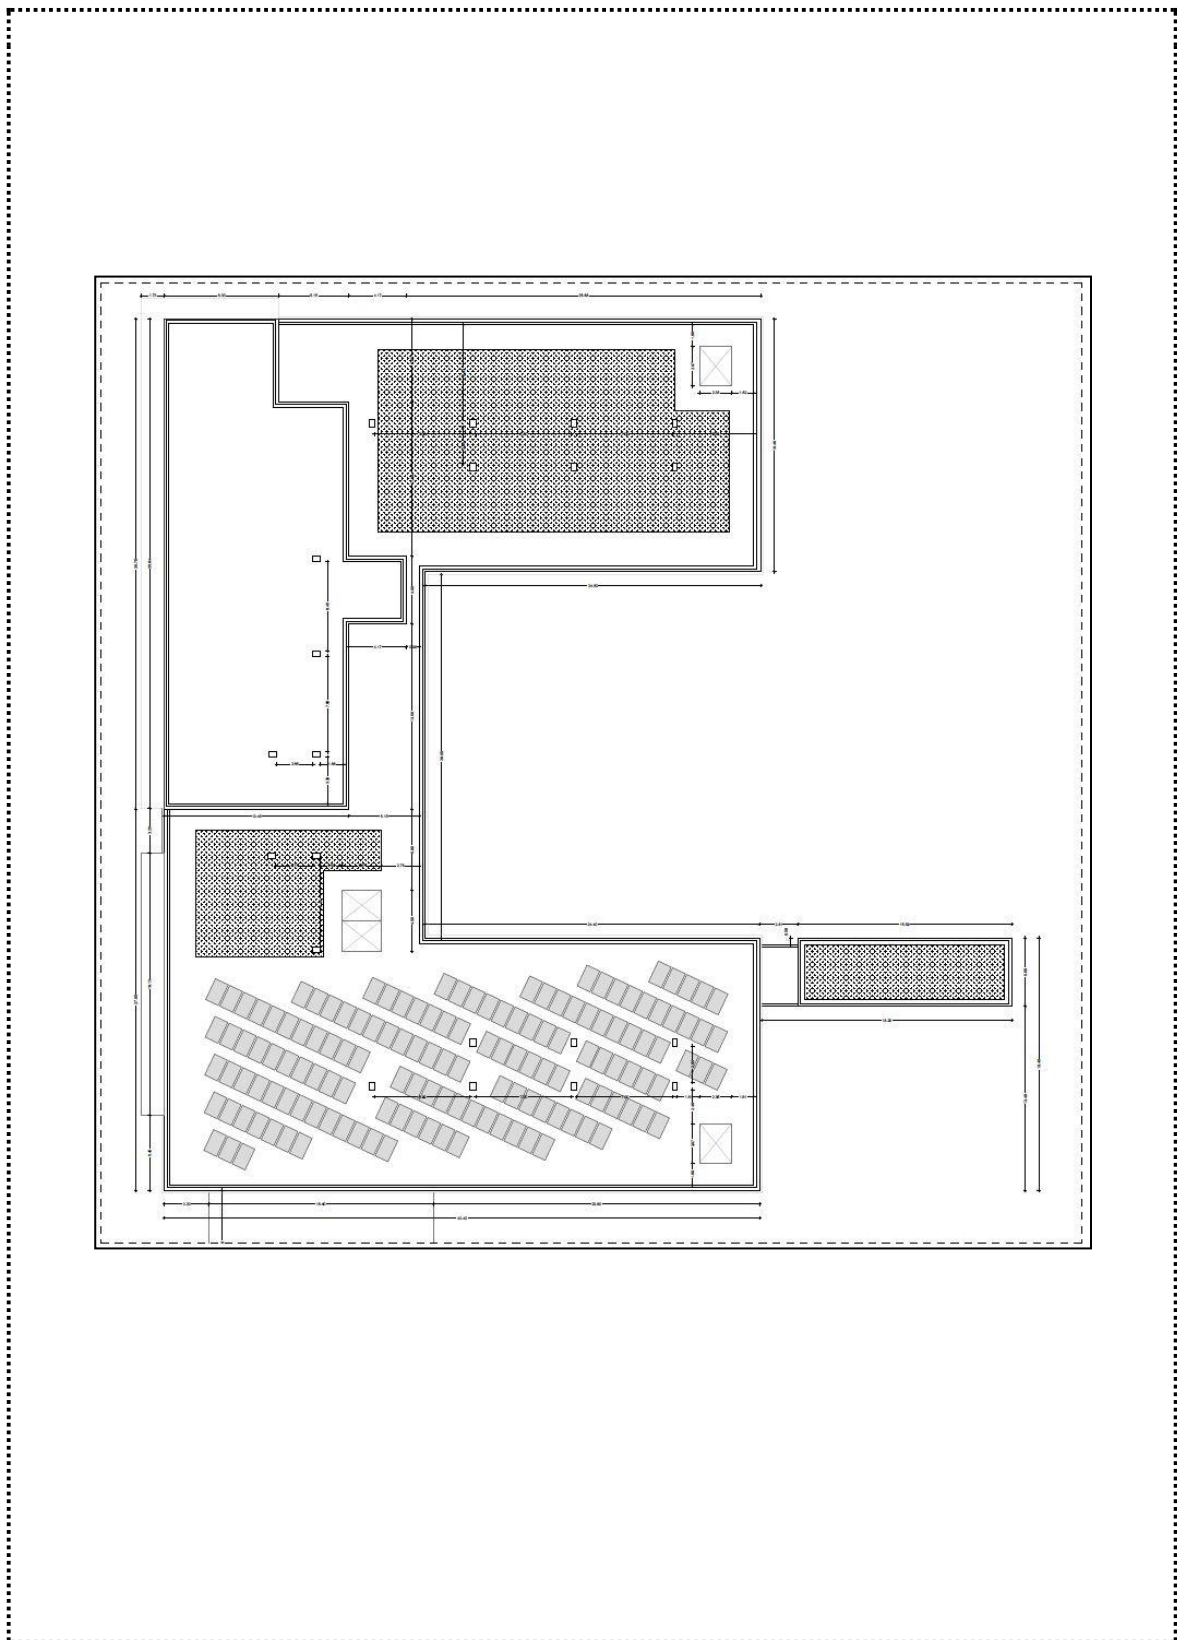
Estratti tavole di progetto – pianta piano copertura RSA (T.11)
